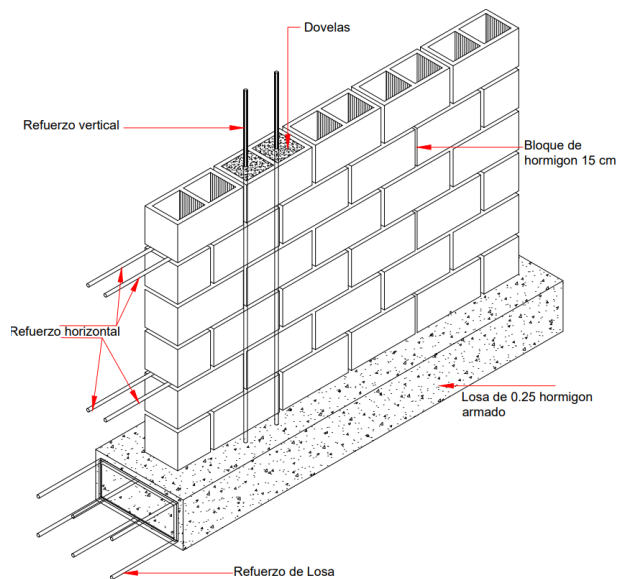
Detalle Constructivo Bloque de hormigón Esc 1:20
